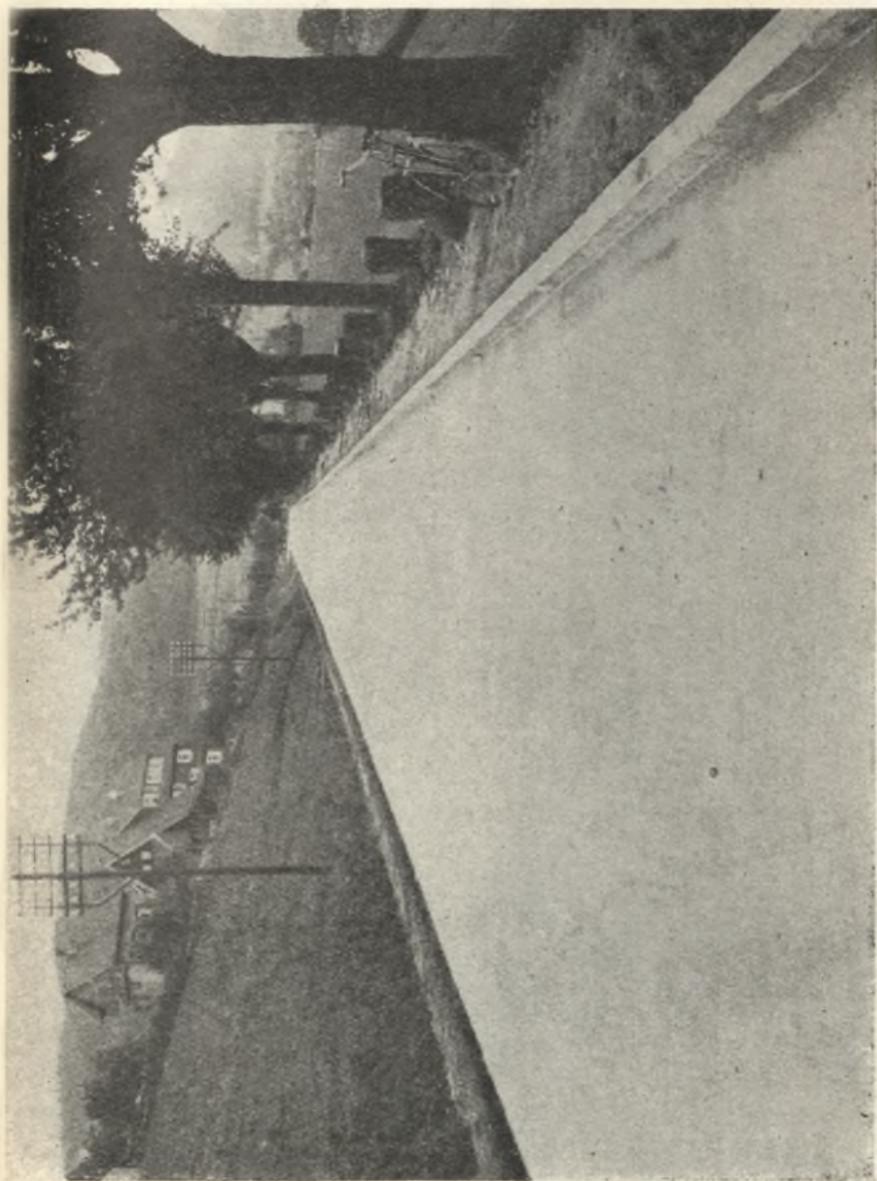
Solidit-Betonstraße am Bahnhof Baiersbronn.
